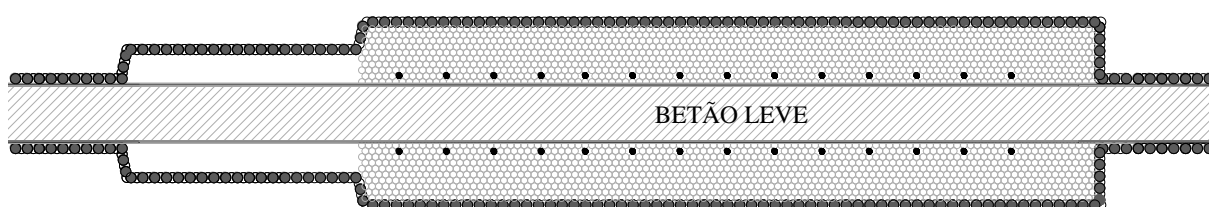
Vista em planta da laje-escora de jet-grouting ao nível do equador do túnel
